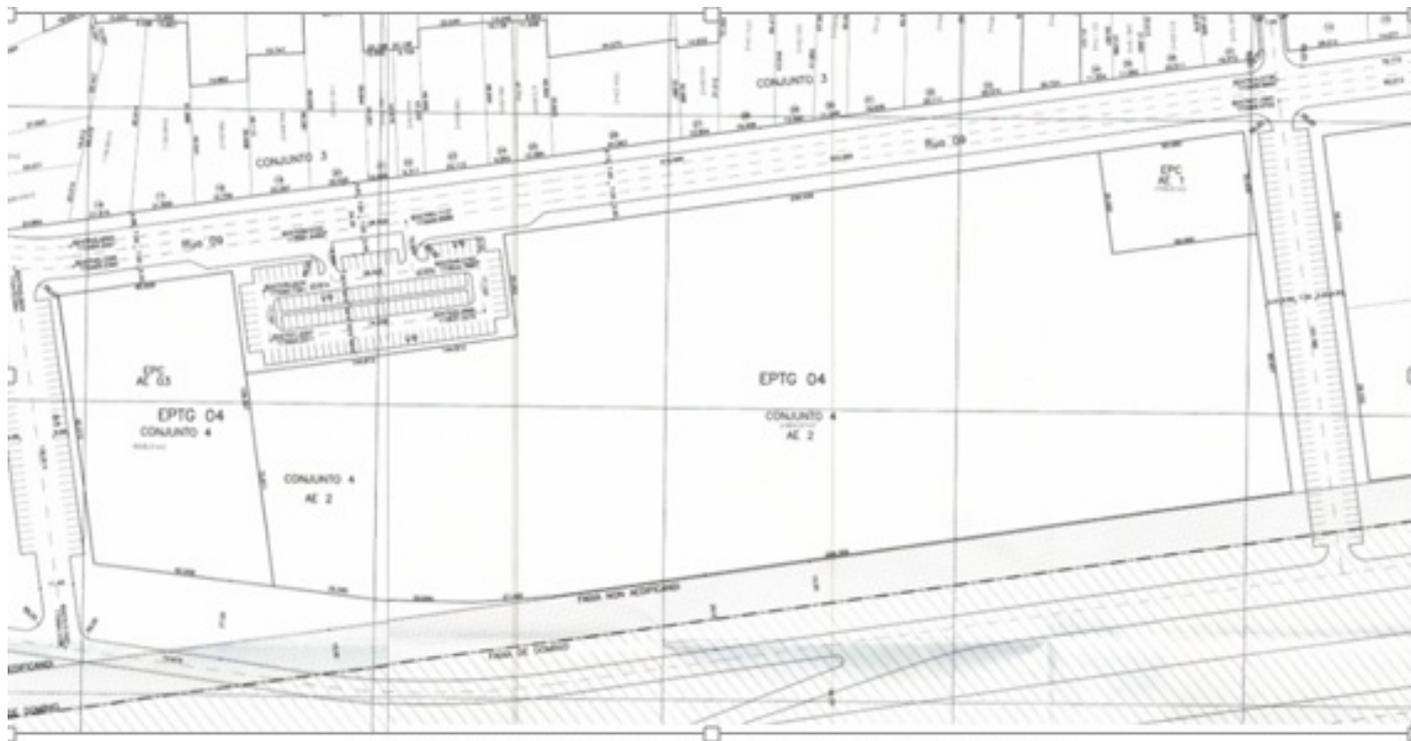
Lote original URB 66/13 (folhas 26 e 27/29)
